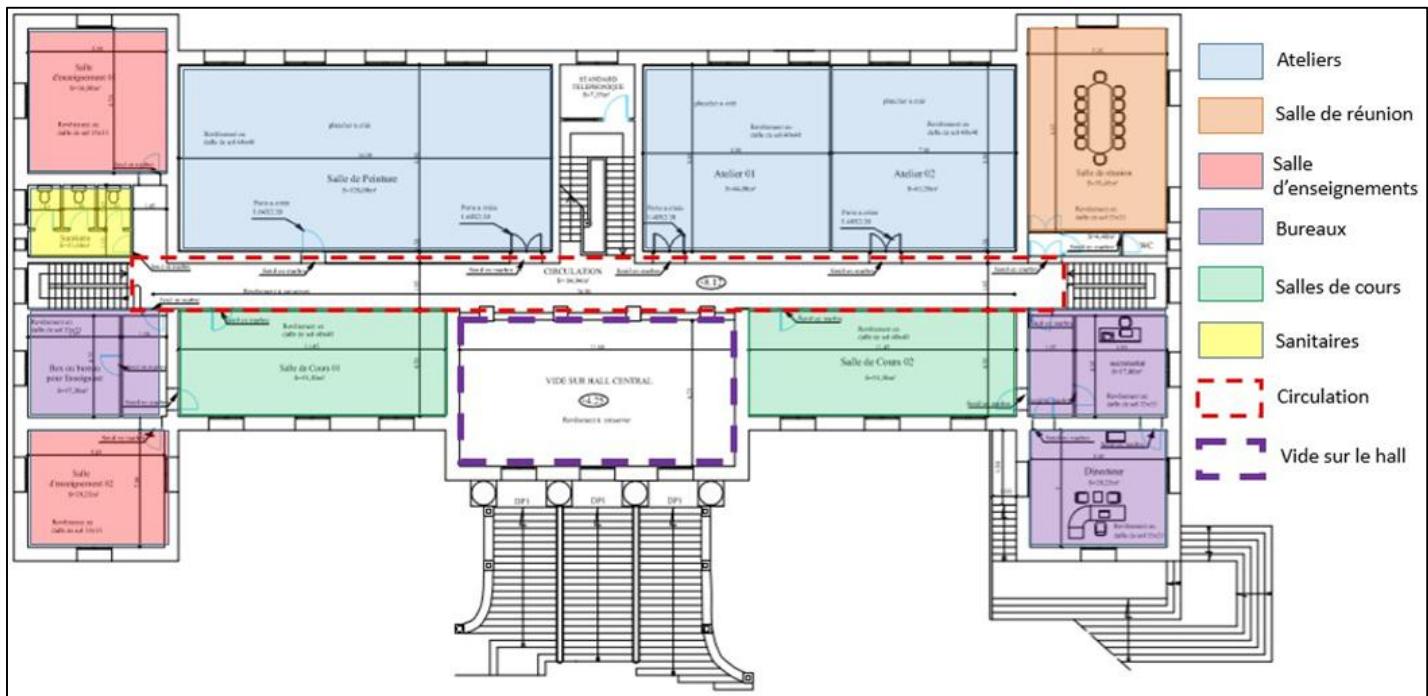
Plan d'étage (Fond : plan de la direction de l'urbanisme. Traitement : auteur 2025.).
